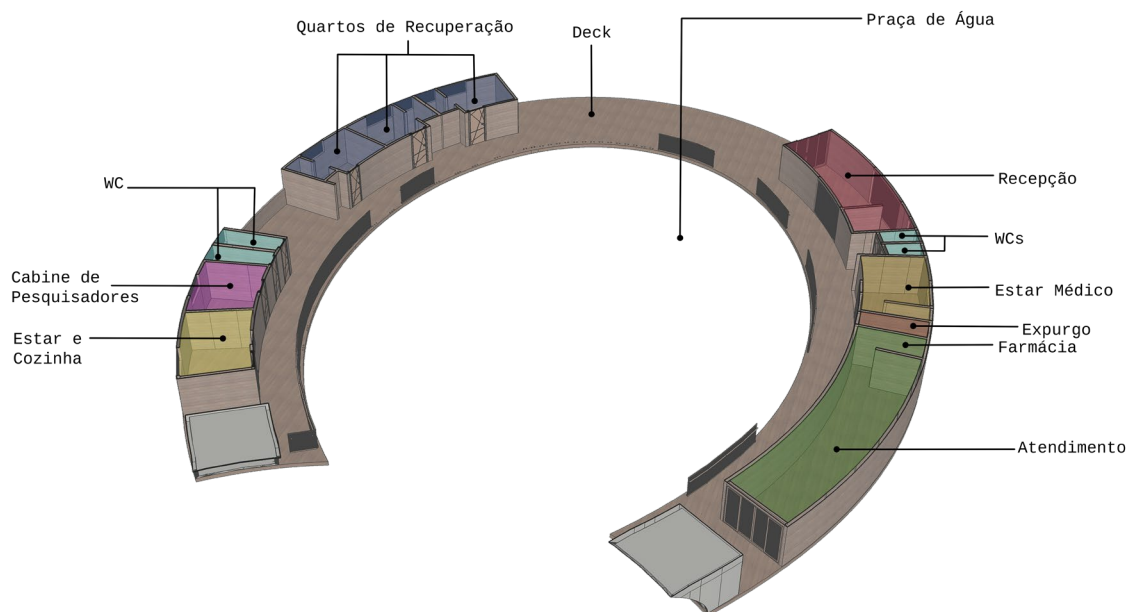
Layout Portinho / Fonte: Produção autoral do grupo.
